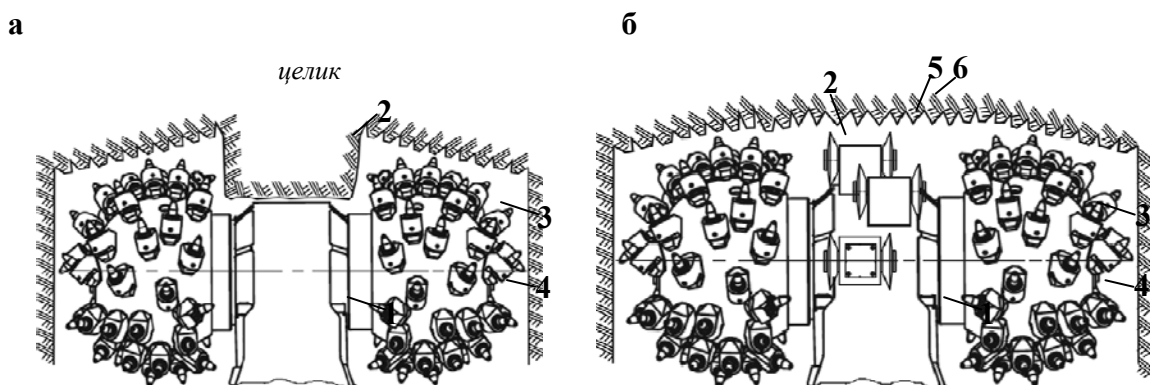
Зарубка исполнительных органов: а – типового аналога; б – при использовании дисковых инструментов с четырехгранными призмами на раздаточном редукторе
